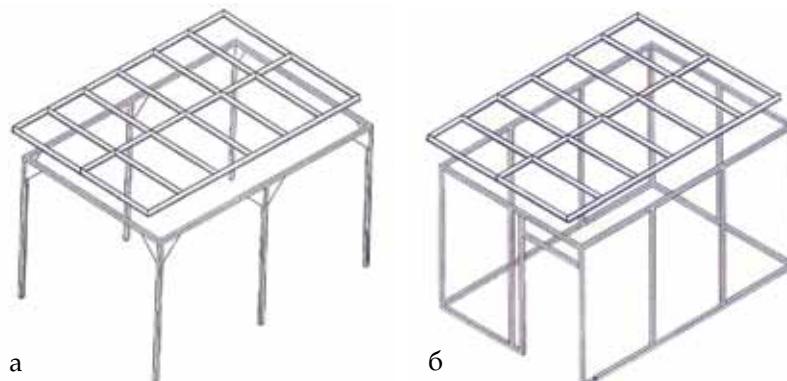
Несущие конструкции: а – с мягкими стенами; б – с твердыми стенами
